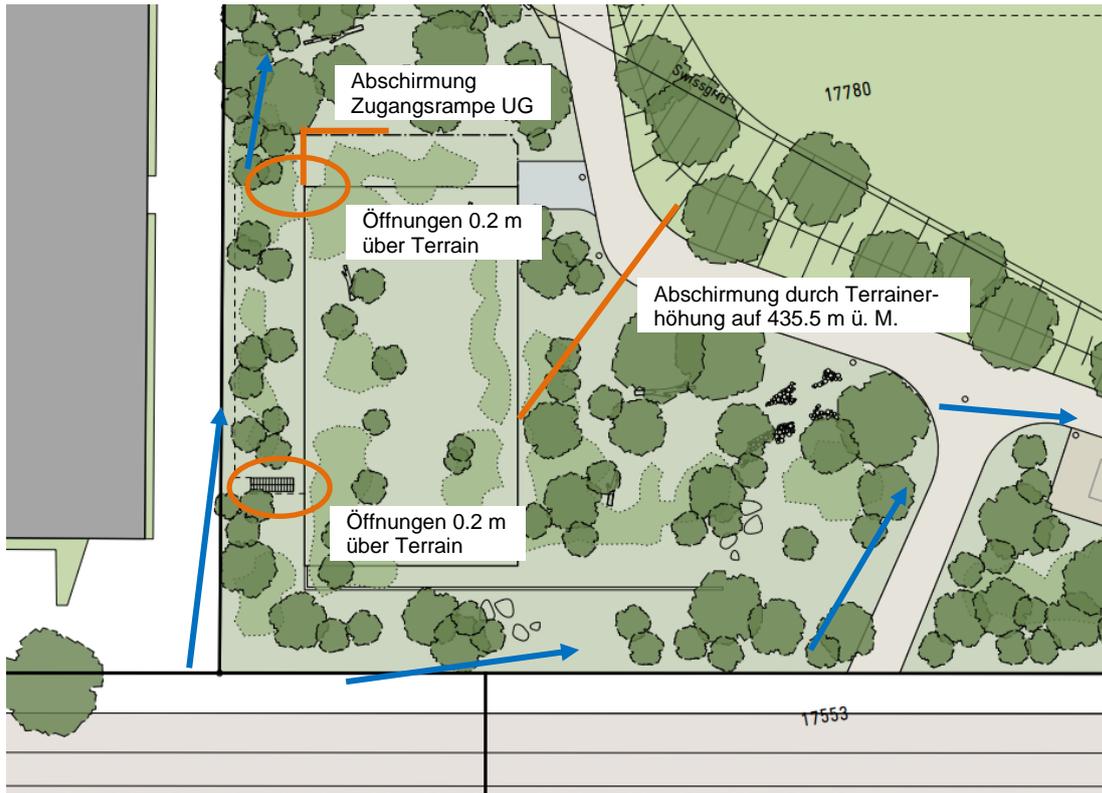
Planausschnitt Bewilligungsverfahren Sporthalle Hochbord (provisorischer Situationsplan Stand 06.01.2021) mit Massnahmen und Fliesswegen.
